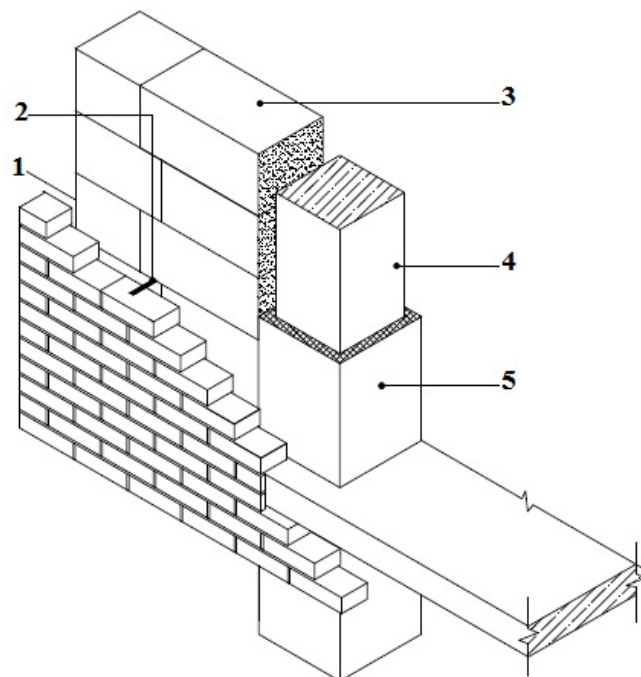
Схематический фасад наружной несущей стены из блоков YTONG с облицовкой из кирпича: 1 — воздушный зазор, 30–40 мм; 2 — связь; 3 — блоки YTONG; 4 — монолитная колонна; 5 — минераловатная плита
